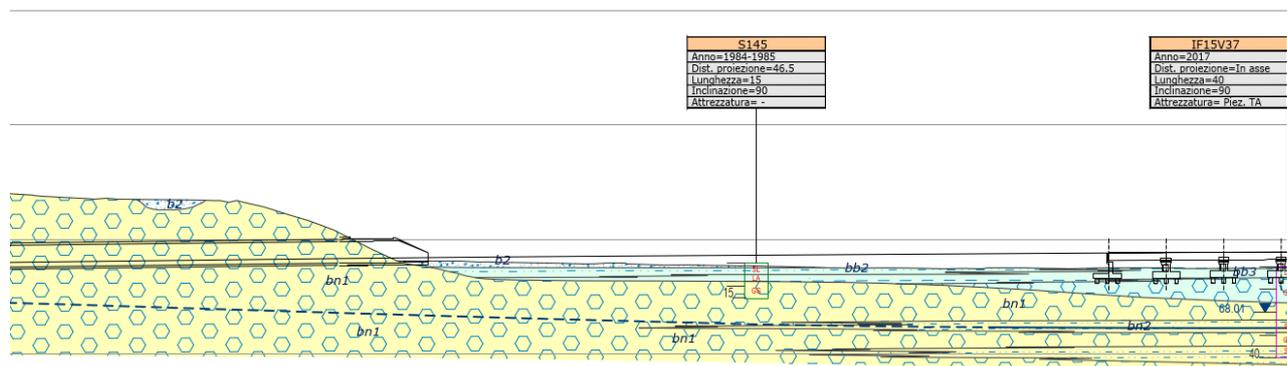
Sezione geologica del versante su cui insiste l'imbocco lato Benevento della galleria Ponte.
